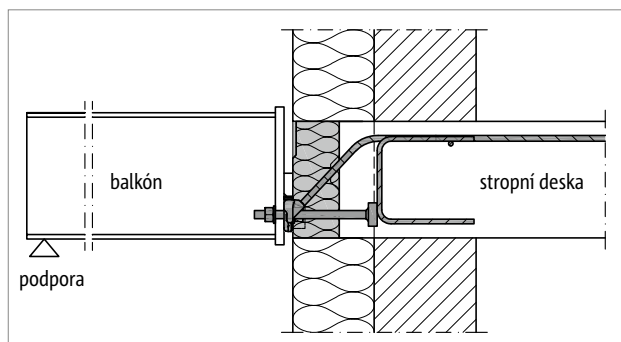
Schöck Isokorb® T typ SQP-WU: Atypické provedení; nutné u napojení na železobetonovou stěnu
